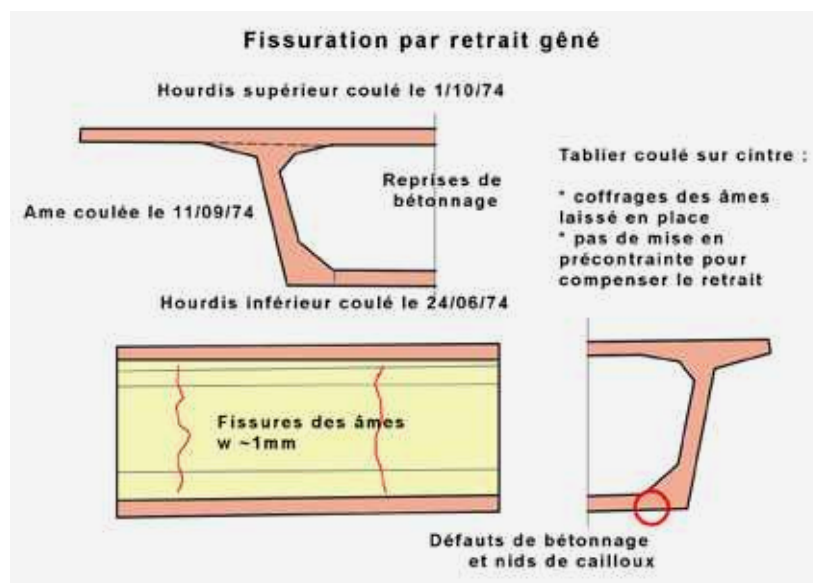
fissuration d'une poutre-caisson sous les effets des retraits
